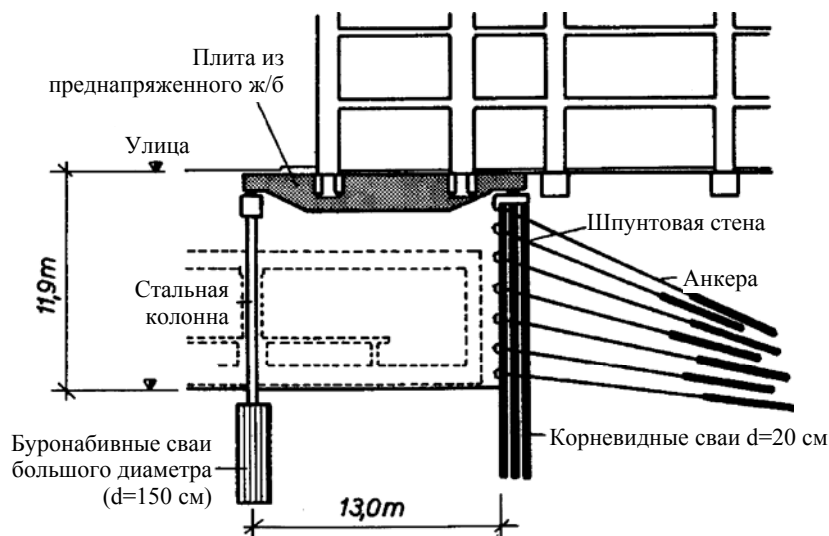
Усиление существующего здания во время строительства метрополитена в Гамбурге: балочная конструкция из преднапряженного железобетона опирается на армирующую стену и стальные колонны на буронабивных сваях большого диаметра
